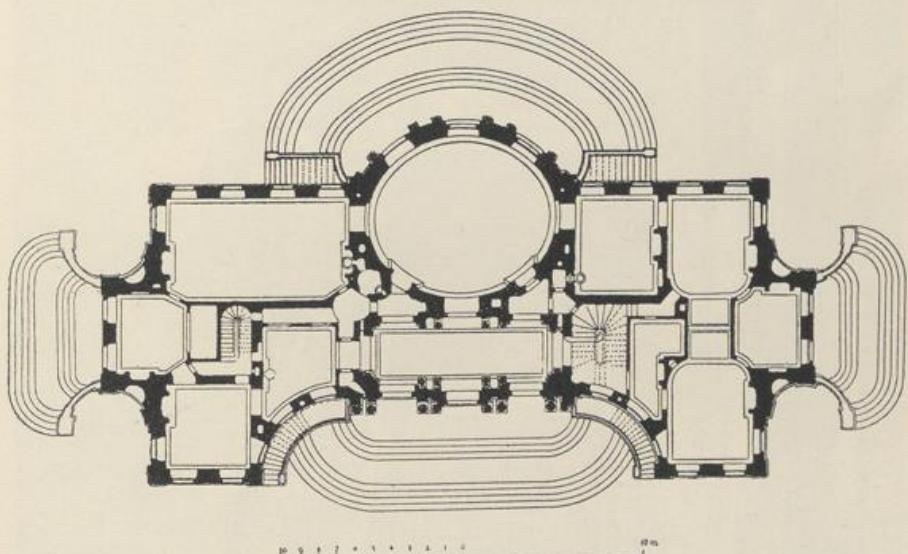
Grundriss des Schlosses Monrepos bei Ludwigsburg
